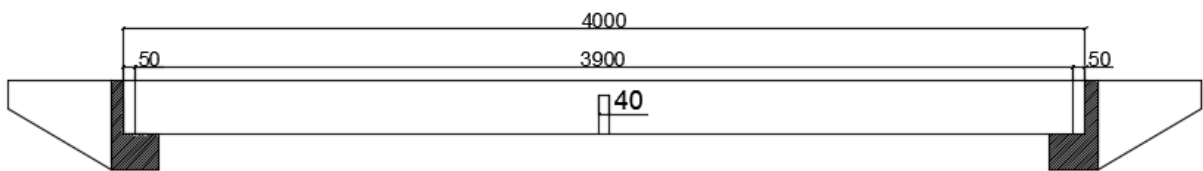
Detalhes da viga A (nos apoios) e B (no meio do vão).
